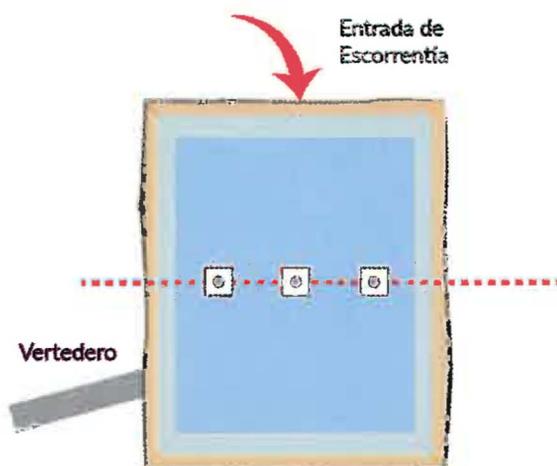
Ejemplo de posibles puntos de ubicación de la obra de toma en un reservorio trapezoidal con fondo horizontal o con el punto más bajo hacia el medio. Fuente: CATIE.
